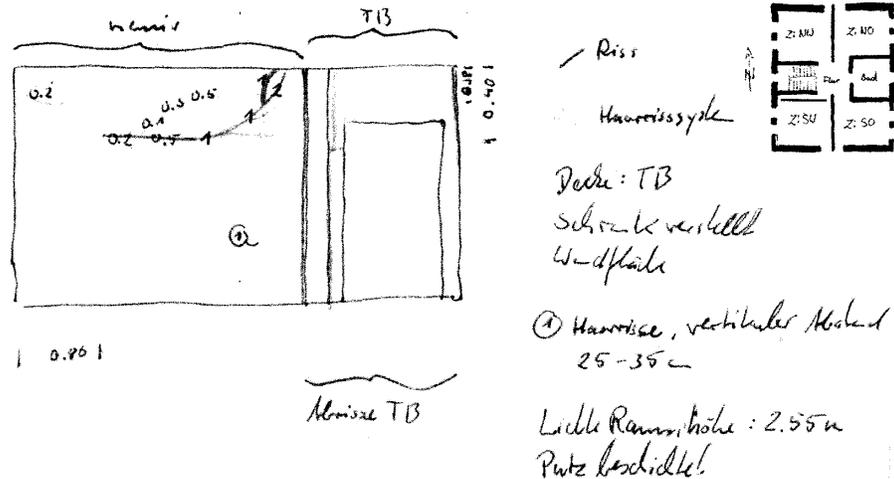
Obergeschoss, Zimmer Südwest, Risskartierung Nordwand
